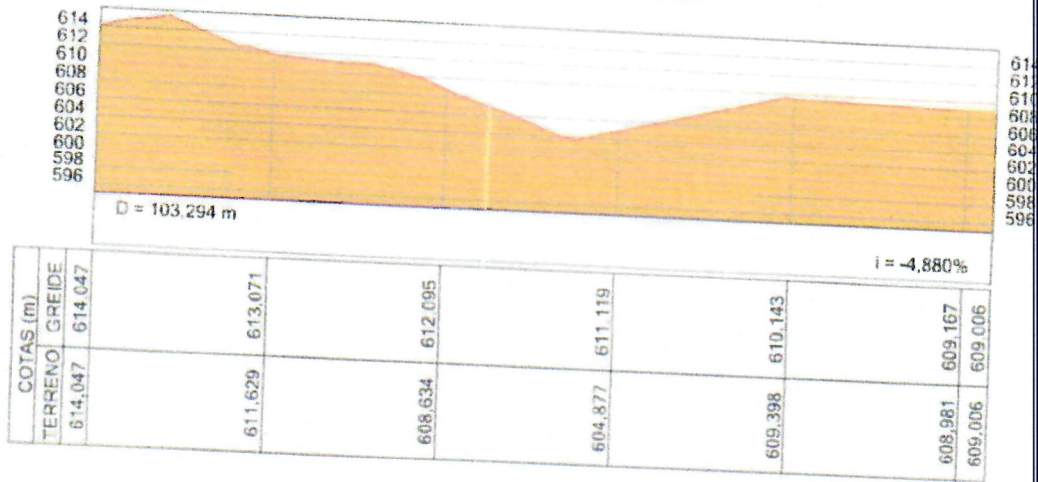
Perfil transversal atual e final da área de extração até esgotamento da jazida. Sem escala.
